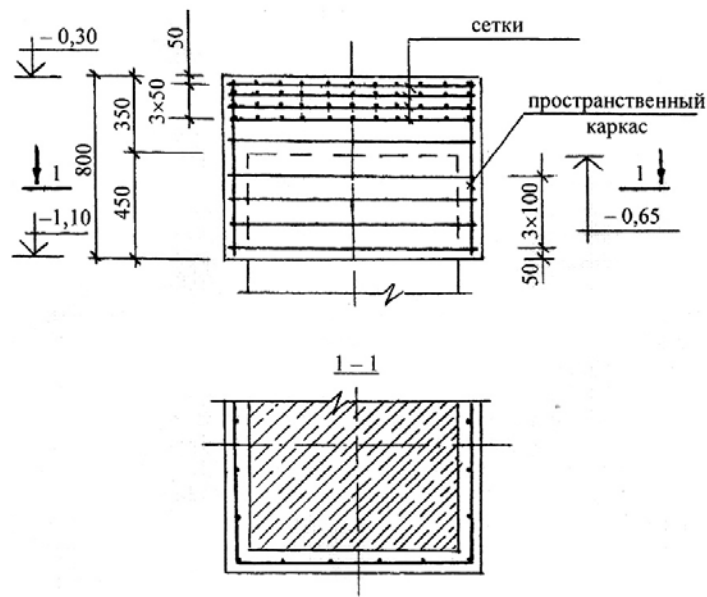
Конструкция наращивания подколонника фундамента (фундаментные болты условно не показаны).
